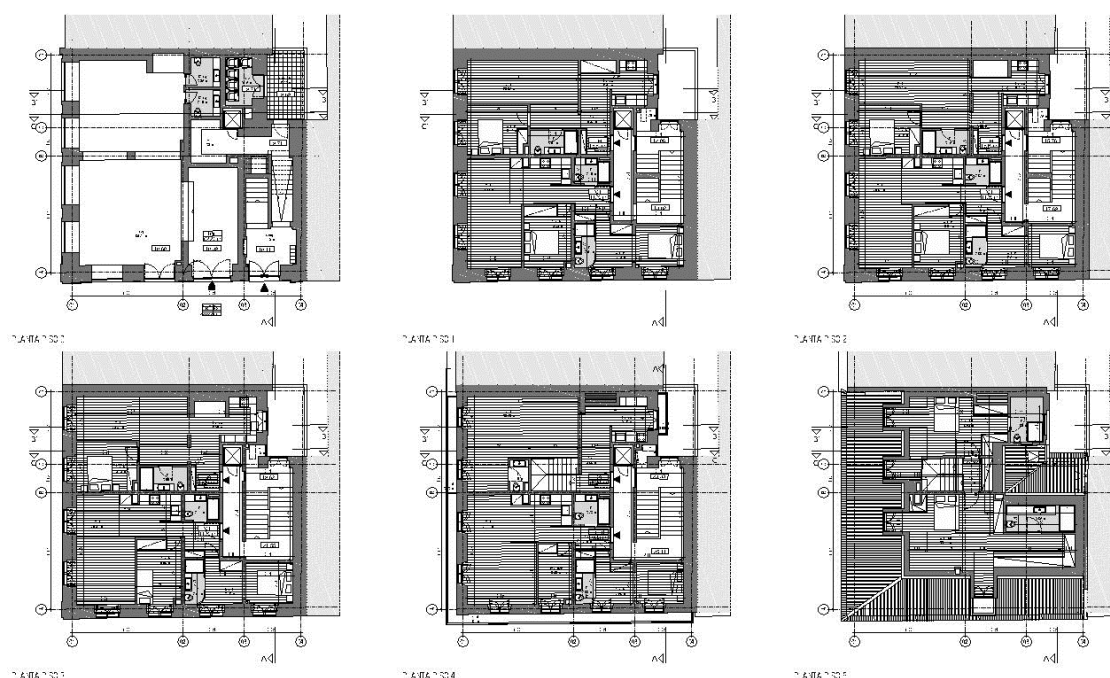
Peças desenhadas Planta Proposta. (Saraiva & Associados, 2017a).
